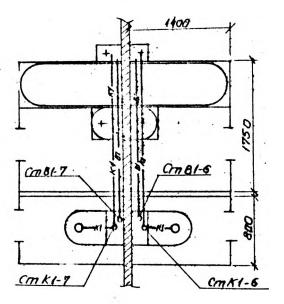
Трассировка водопровода и канализации на плане санитарных уэлов:
